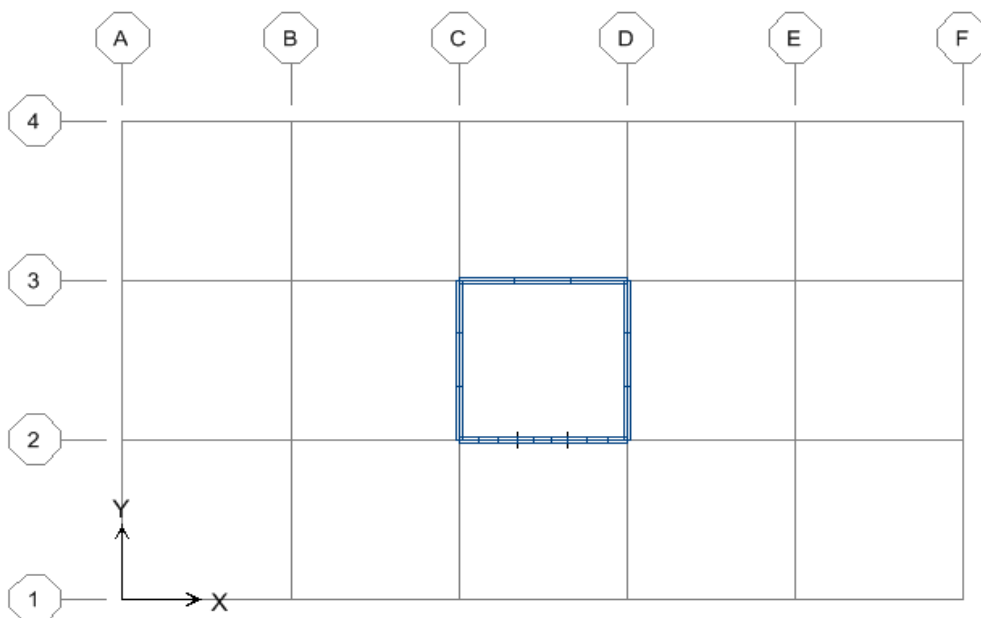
Disposition du noyau en béton armé dans la structure en (R+4)
